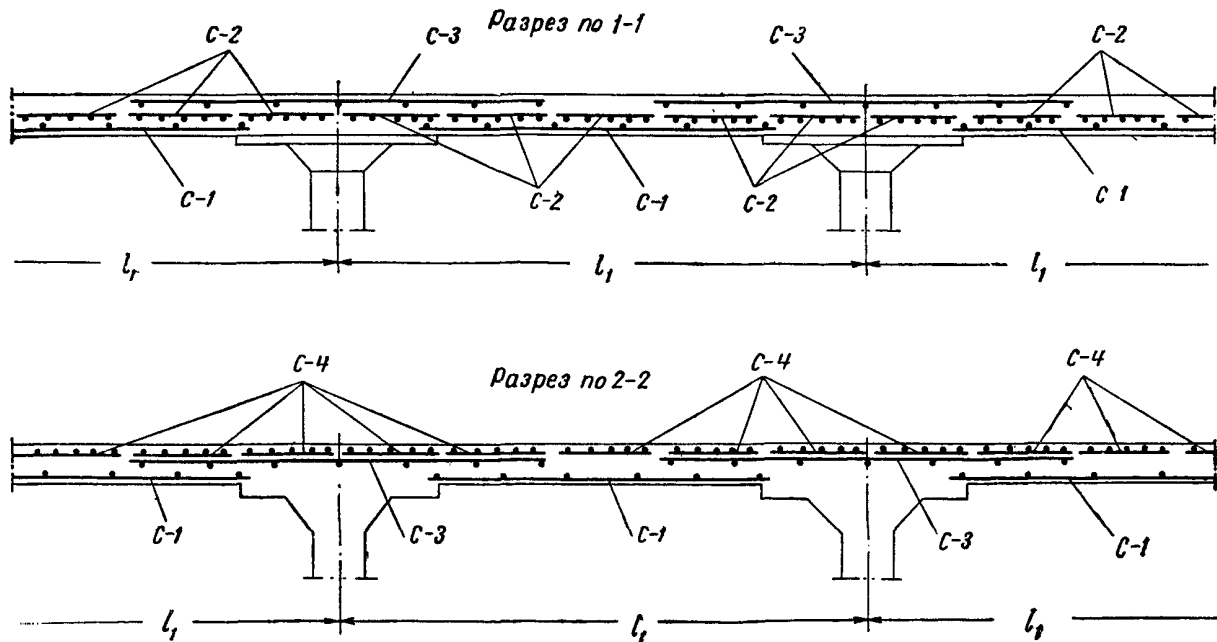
Армирование безбалочных перекрытий узкими сварными сетками с продольным расположением рабочей арматуры
